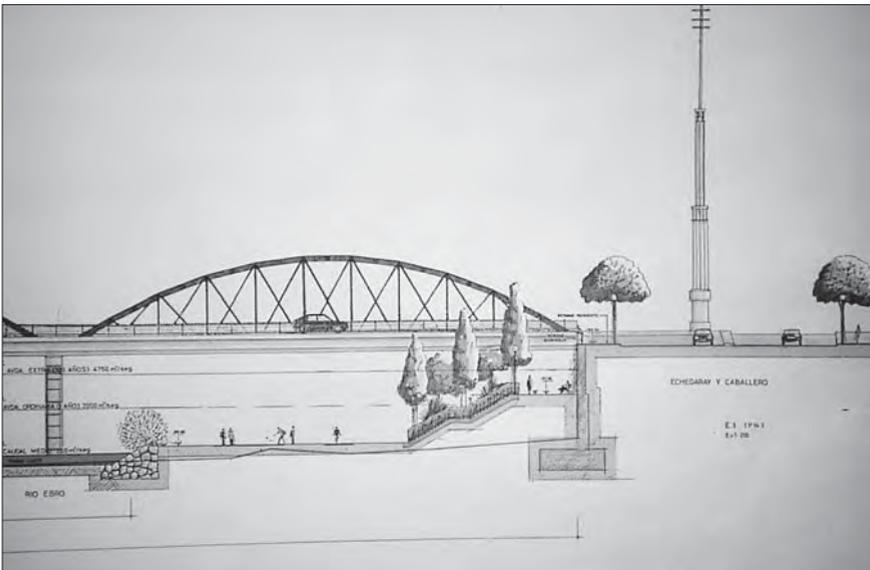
Perfil transversal de la margen izquierda en el puente de Hierro o del Pilar.
